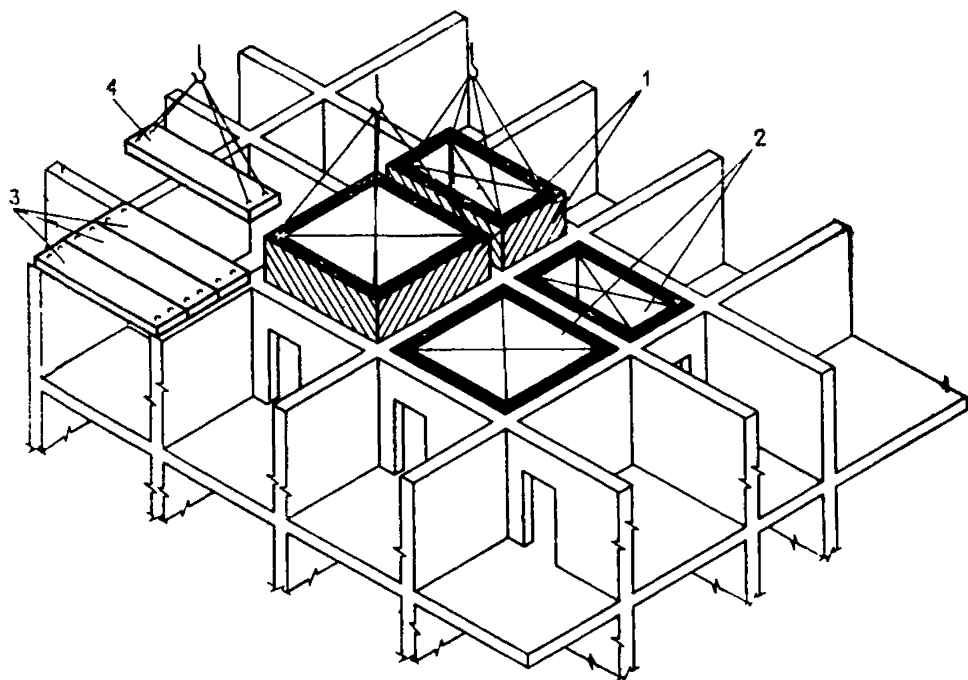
Здание из монолитного железобетона, возводимое в тоннельной опалубке
